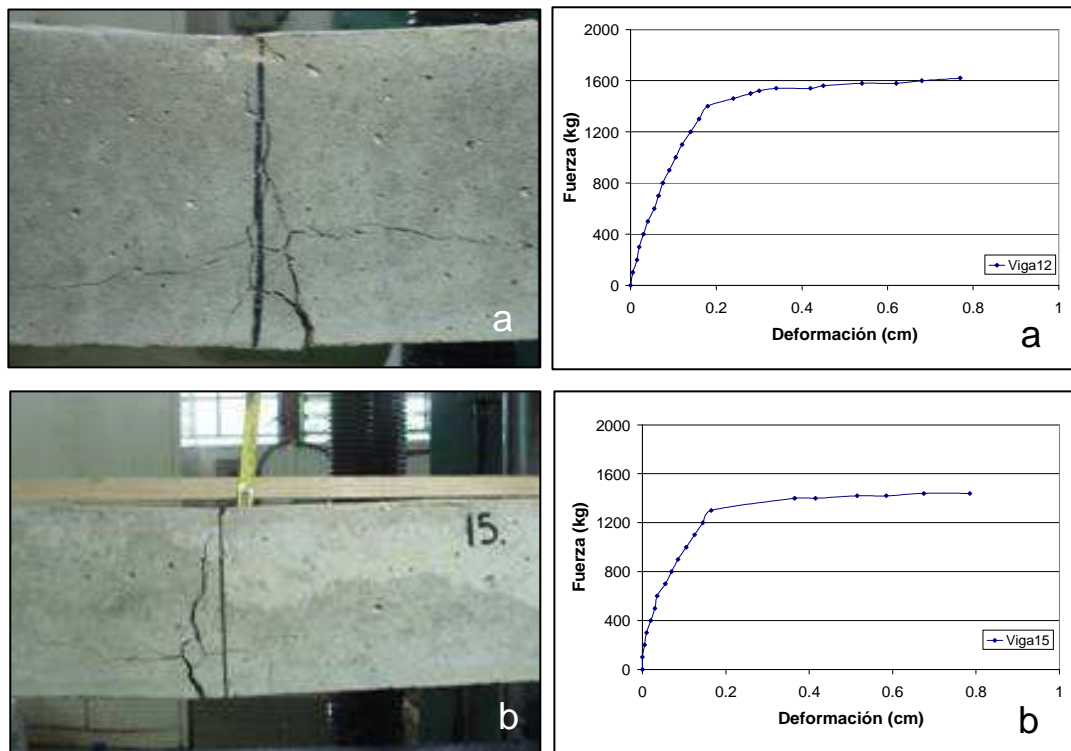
Vigas precargadas por dos años. Con fisuras por corrosión.
